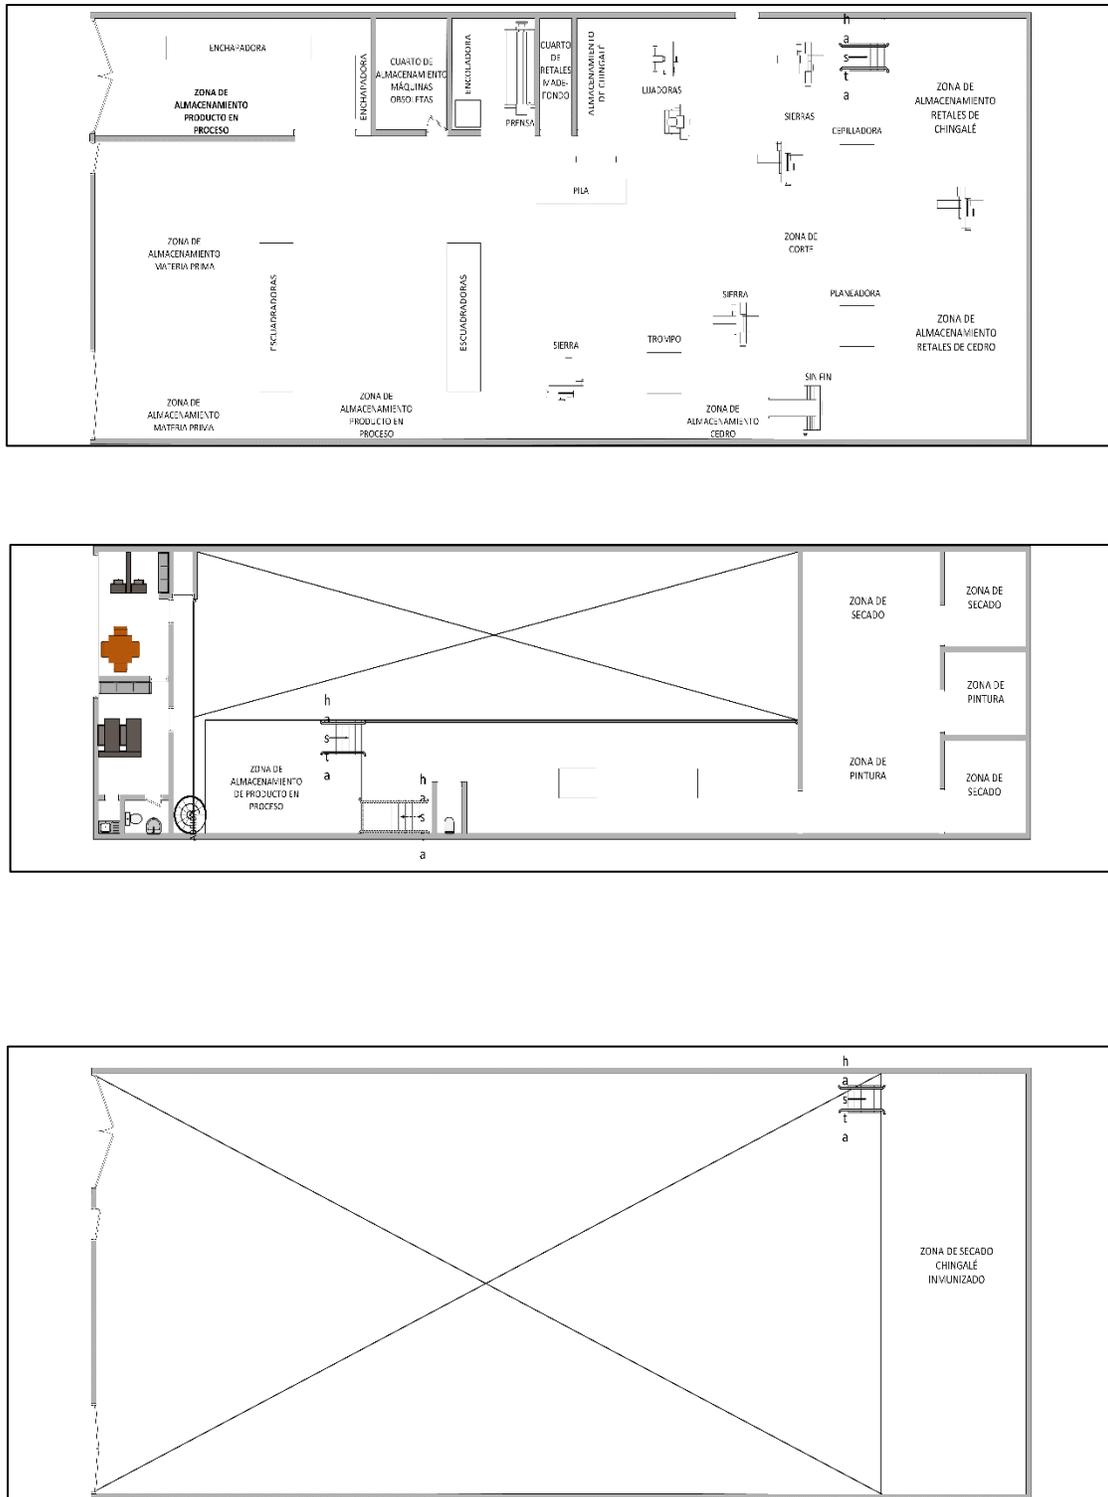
Planta de la empresa Muebles MAG S.A.S.
